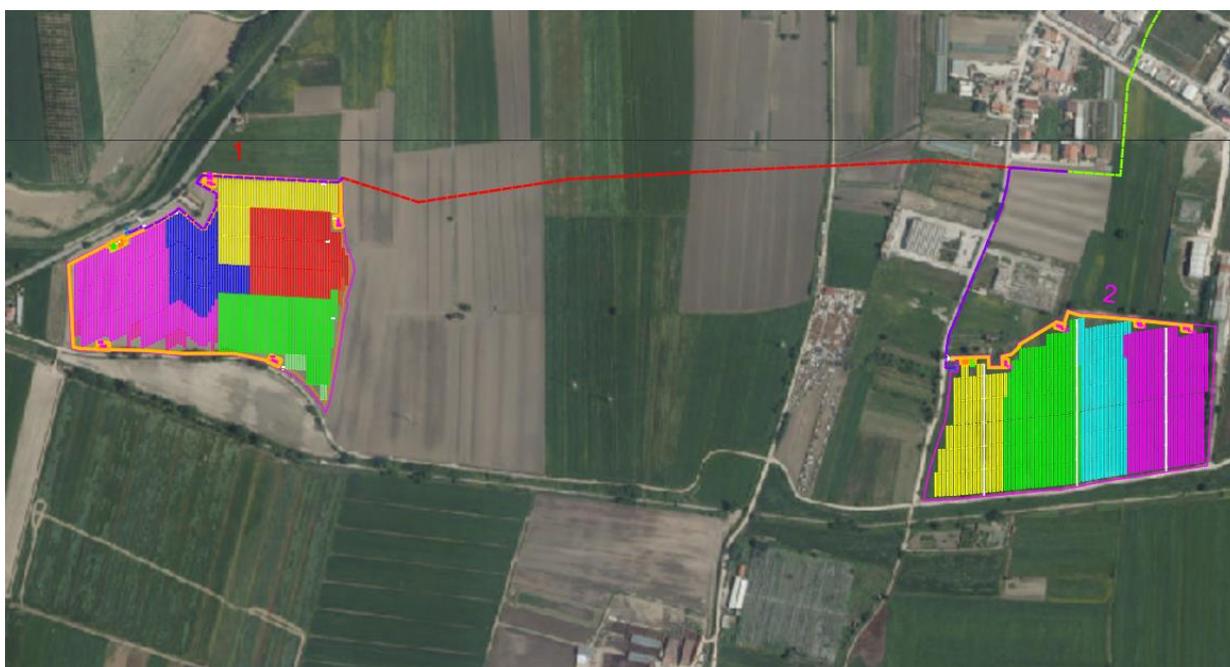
Inquadramento su ortofoto delle aree di impianto.
